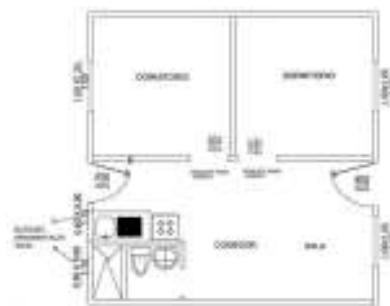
Plano arquitectónico del modelo tipo “Sierra- Oriente 1”
